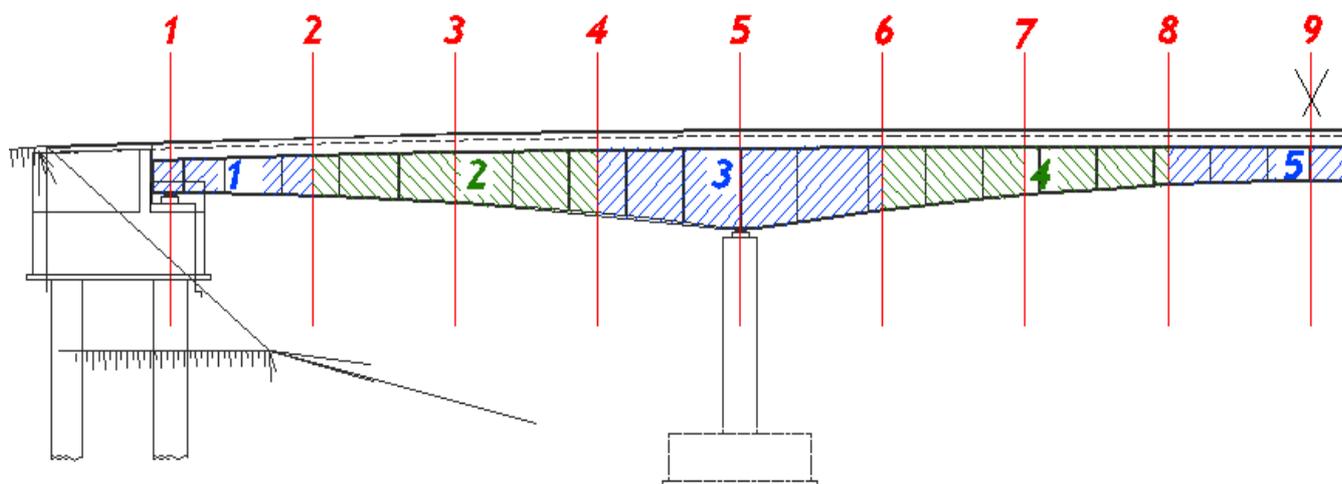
SUDDIVISIONE DELLE TRAVI IN CONCI
